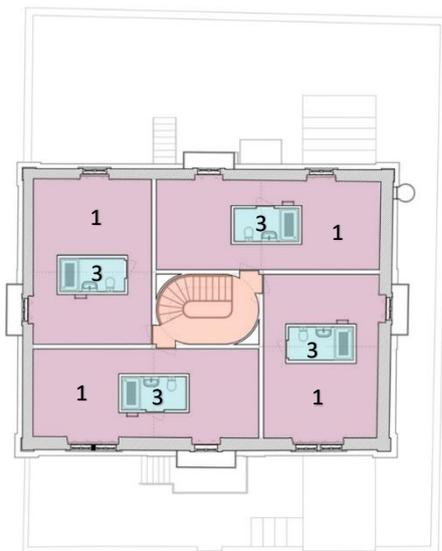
Planta Subsolo – Fonte: Archdaily, 2017
